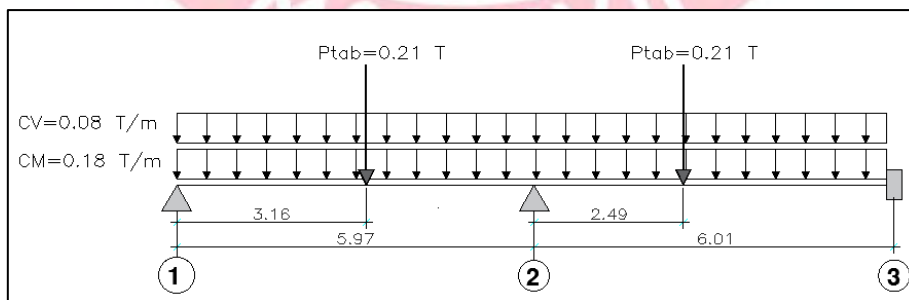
Metrado de cargas de gravedad sobre vigueta entre ejes “1”, “2” y “3” (piso típico).
